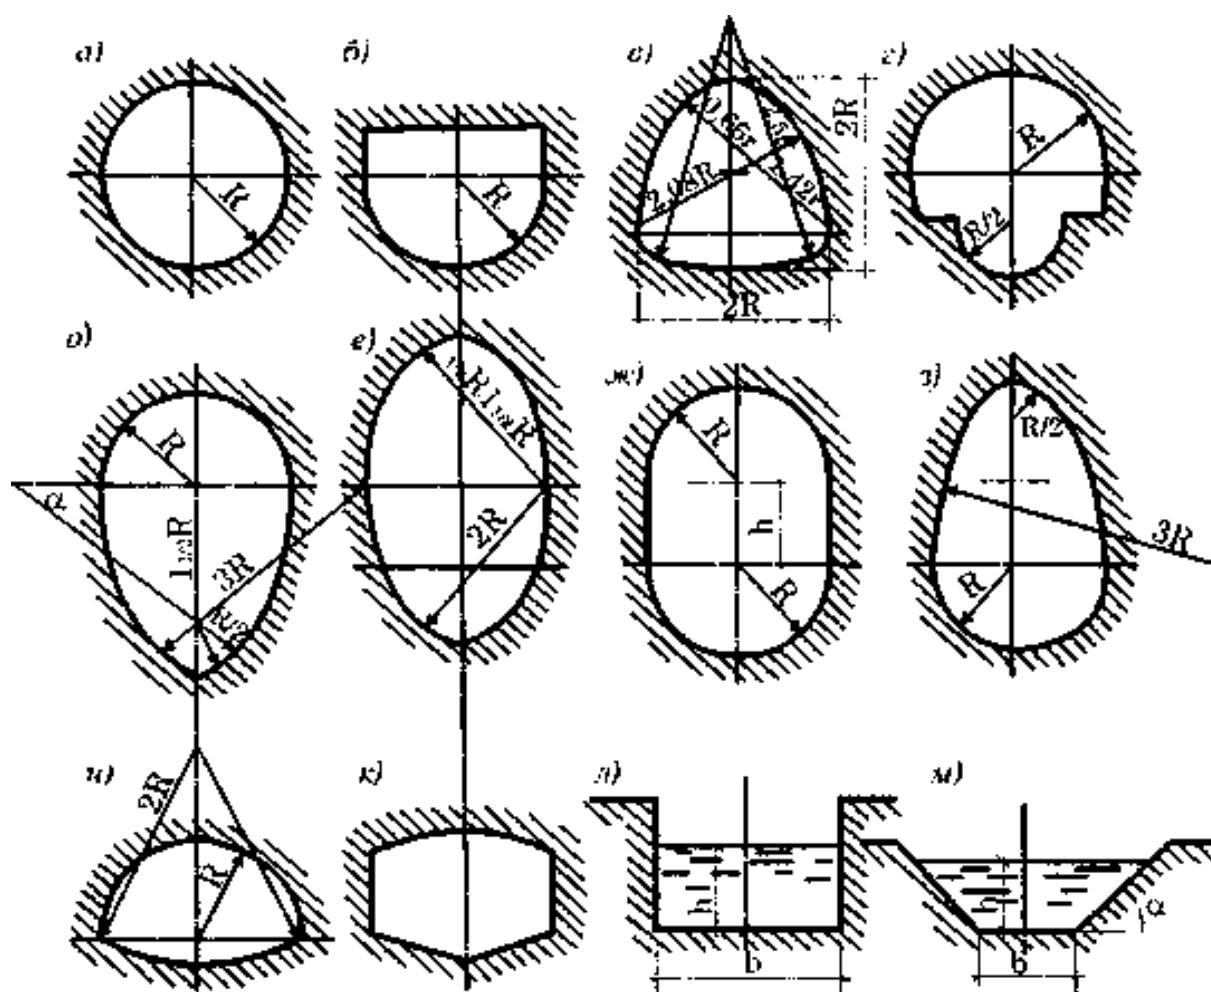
Формы поперечного сечения водоотводящих труб, коллекторов и каналов: а - круглое; б - полукруглое; в - шатровое; г - банкетное; д - яйцевидное (овоидальное); е - эллиптическое; ж - полукруглое с прямыми вставками; з - яйцевидное перевернутое; и - лотковое; к - пятиугольное; л - прямоугольное; м - трапецидальное
